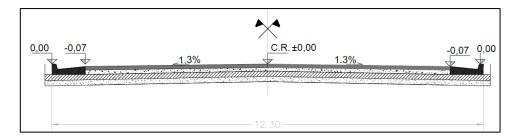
Perfil tipo de calzada en tramo Besada entre alcantarilla y conexión RN127
